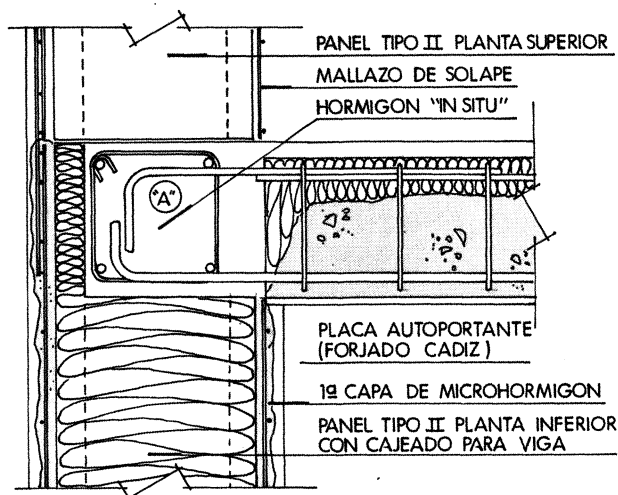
Encuentro entre panel D-P II y forjado en fachada.
